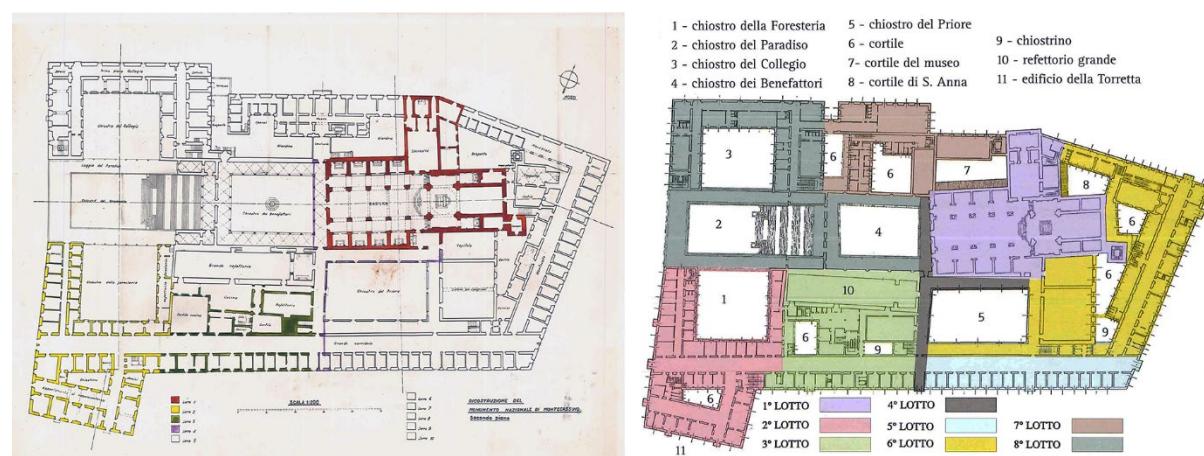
Identificación de los distintos lotes para la reconstrucción de la Abadía. A la izquierda: plano original del proyecto de reconstrucción (Archivo Privado de la Abadía) con los tres primeros lotes de trabajo (Lote n° 1: Basílica; Lote n. 2: zona de la "Torretta" y entrada PAX; Lote n. 3: Área Archivo-Biblioteca, alojamiento); a la derecha diagrama general de los lotes, con indicación de las zonas de intervención.
